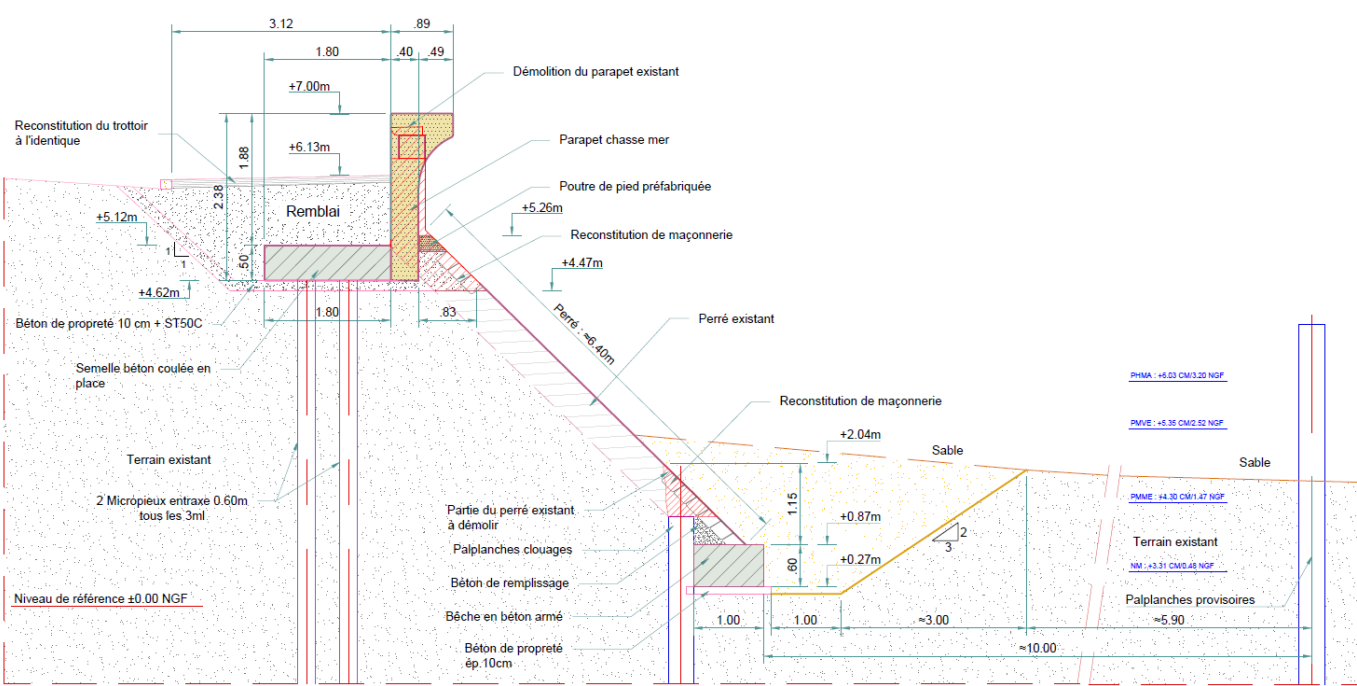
Coupe au droit de la section courante, hors rampes de la piscine
